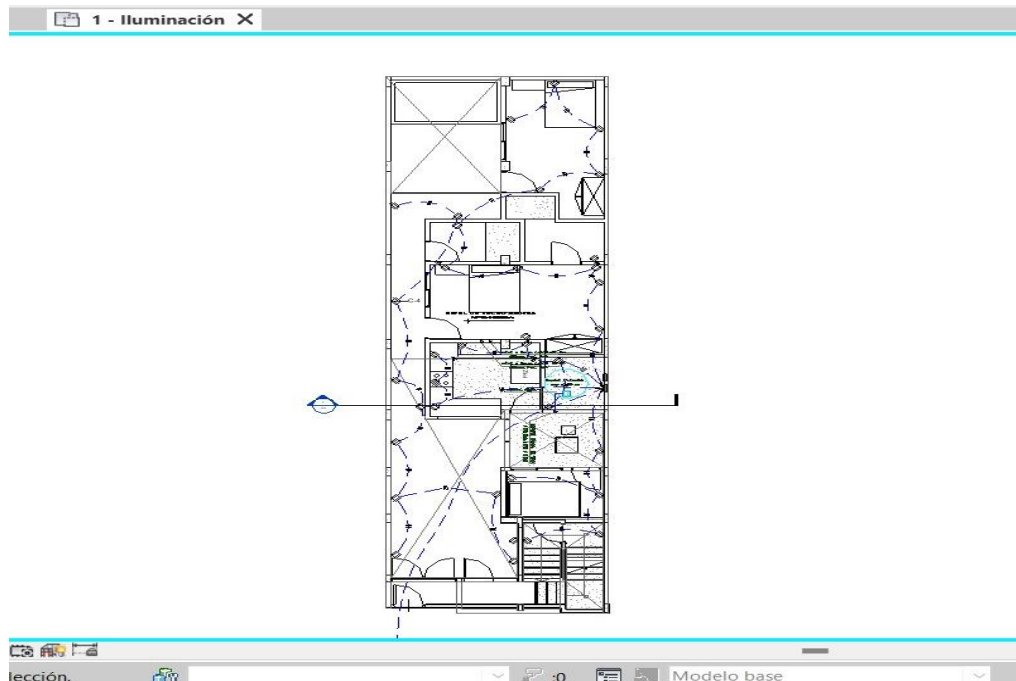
Modelado 3D de IIEE Cableado de 1er Nivel – Vista de Planta.
